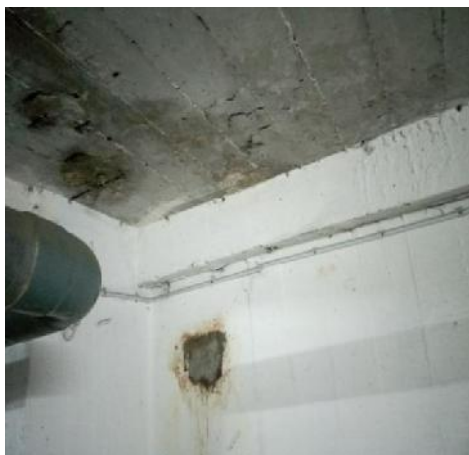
Dévoilement, par carbonatation du béton, des armatures du lit inférieur de la dalle de la cave du bâtiment FORESCOM à Kinshasa
